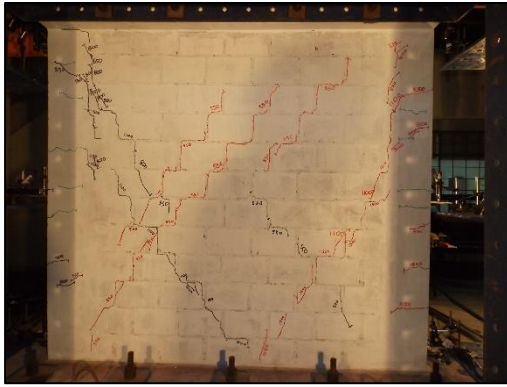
Aparición de más grietas diagonales en el muro para la distorsión  $1/400$ .
